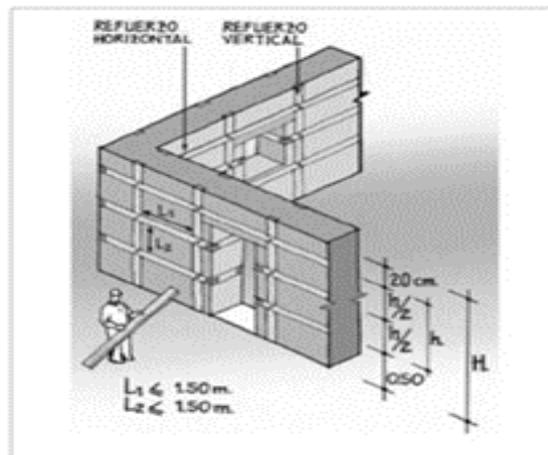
Colocación de refuerzos de madera de confinamiento (AIS, 2004).
